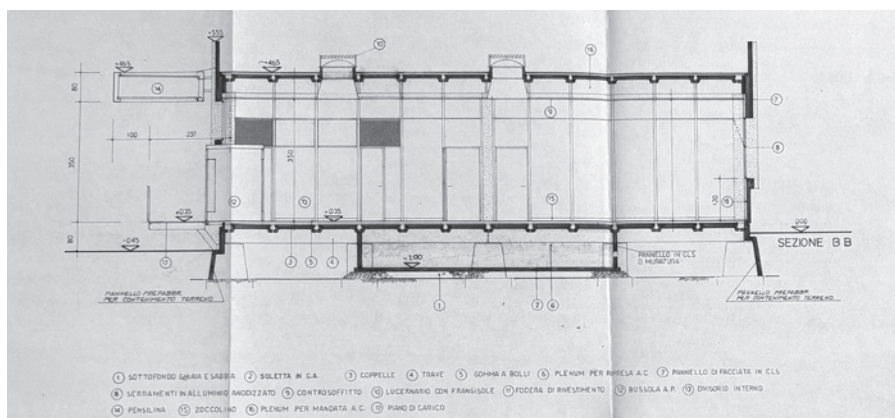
Sezione ufficio D con CTR, con struttura in calcestruzzo armato, progetto IN.CO., 1983 (ASF, b. 147A)
